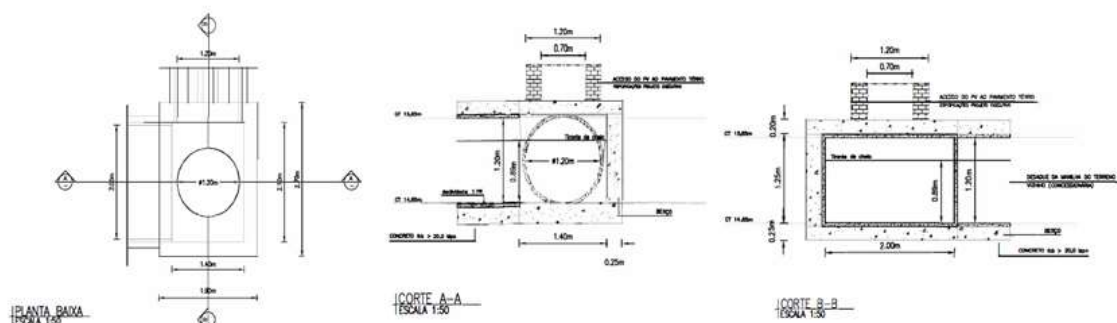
Planta baixa e cortes esquemáticos do Poço de Visita 02 (57185291).
